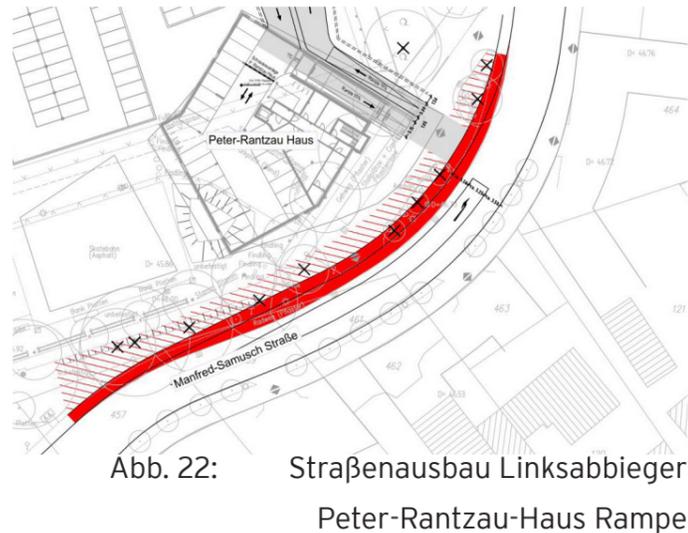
Straßenausbau Linksabbieger Peter-Rantzau-Haus Rampe
